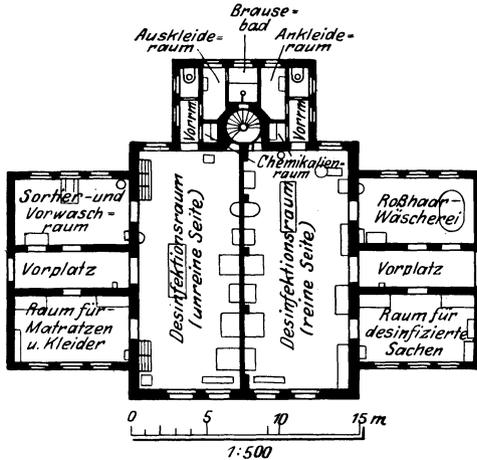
München-Schwabing, städt. Krankenhaus für 1300 Betten, Entkeimungsanstalt.
